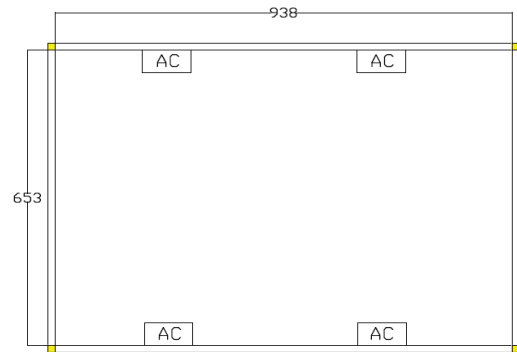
Master Plan Ruang *Filling Rawat Jalan
